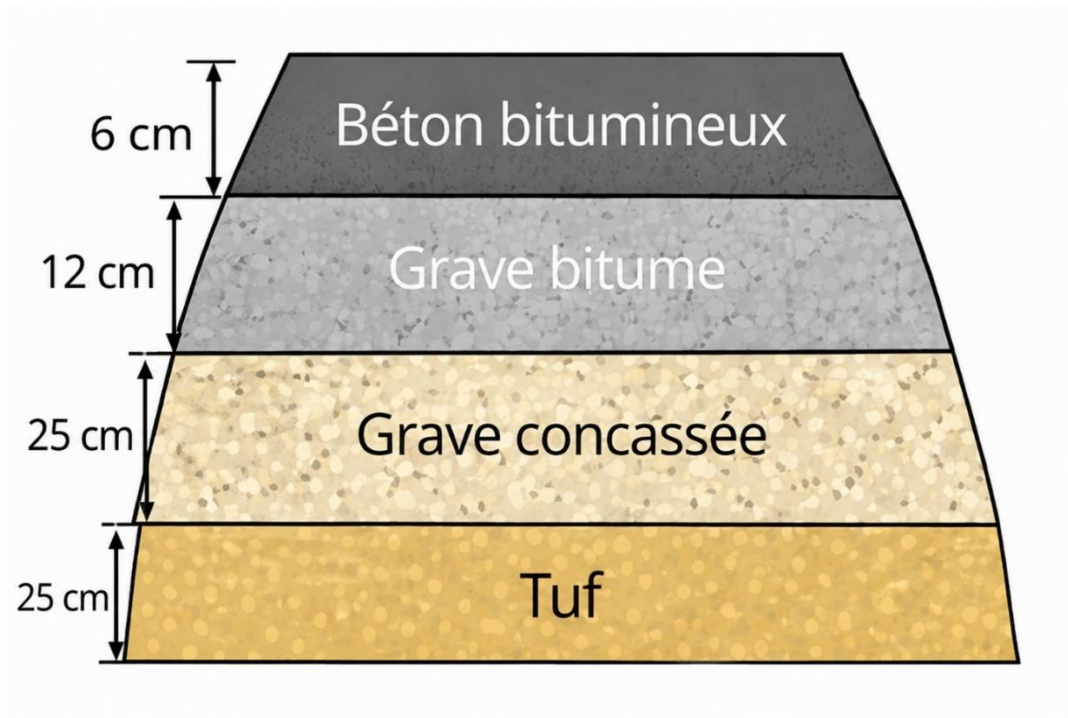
7 - structure de chaussée souple « crée à l'aide d'un outil IA »
